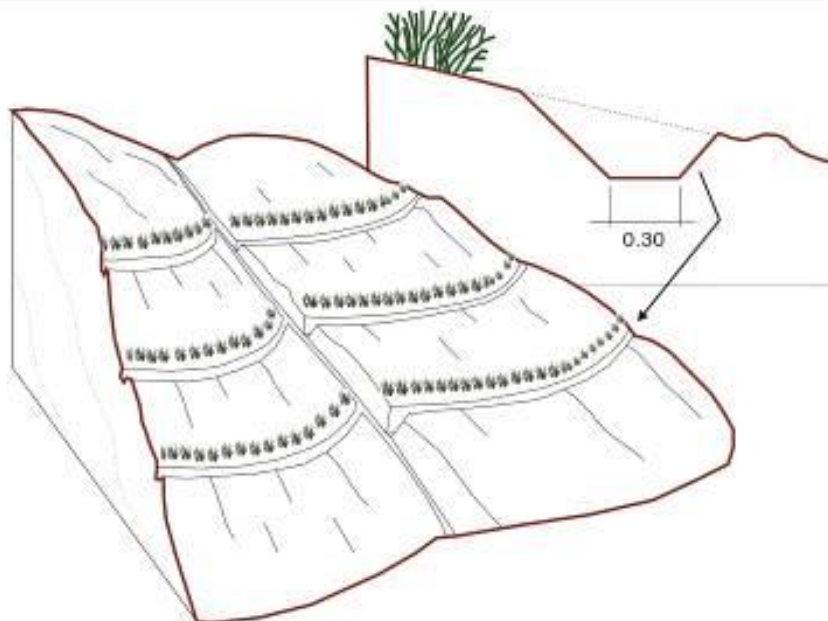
Sistema de drenaje en laderas ocupadas por cultivos
